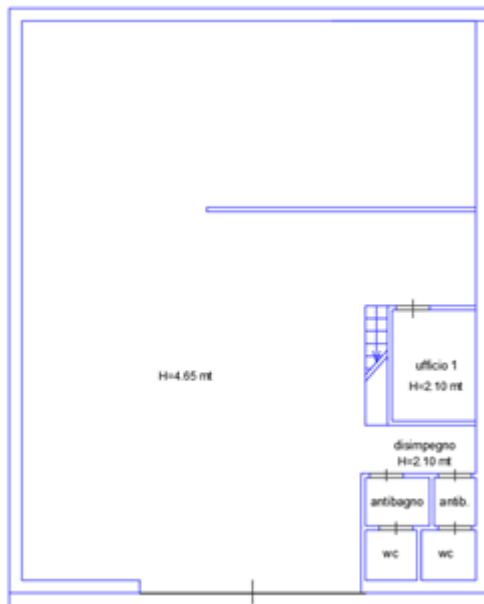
LOTTO 3 planimetria rilevata piano terra
